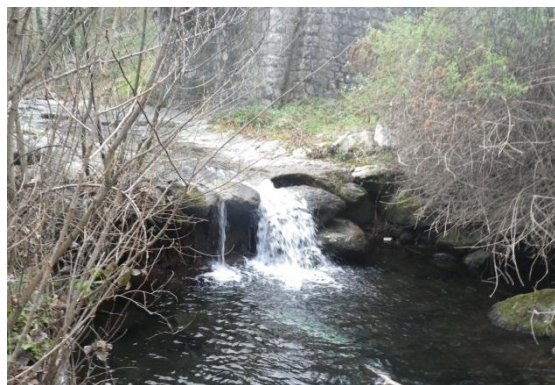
Seuil de stabilisation du pont de la D27 à Taurinya (LLI05 – Non ROE)
